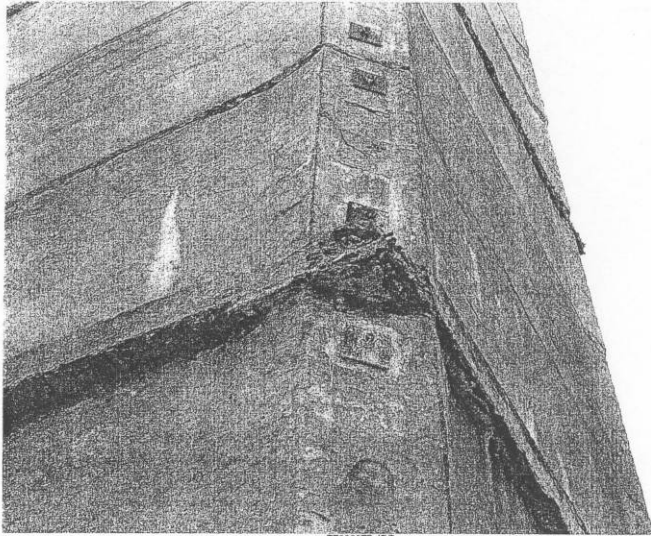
Обнажение рабочей арматуры в плитах перекрытия
